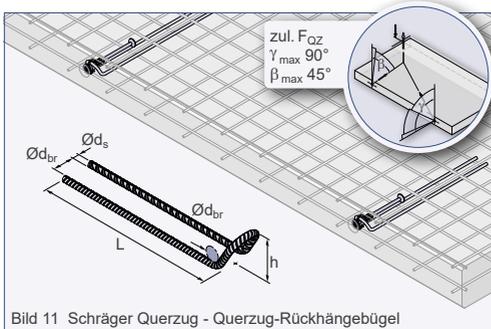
Schräger Querzug - Querzug-Rückhängebügel
